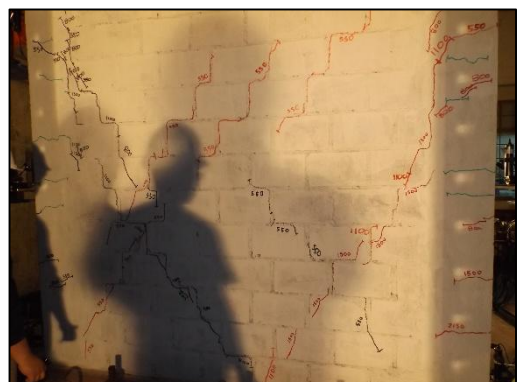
Aparición de grietas diagonales en el muros para la distorsión 1/550.
